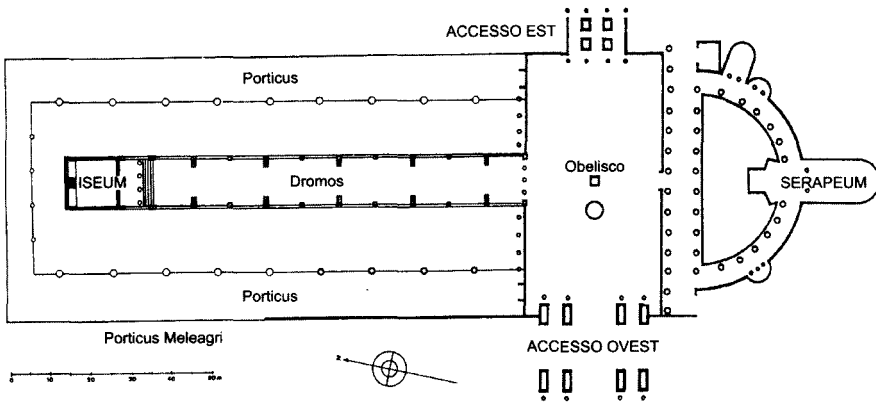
Planimetria dell'Iseum et Serapeum del Campo Marzio.
